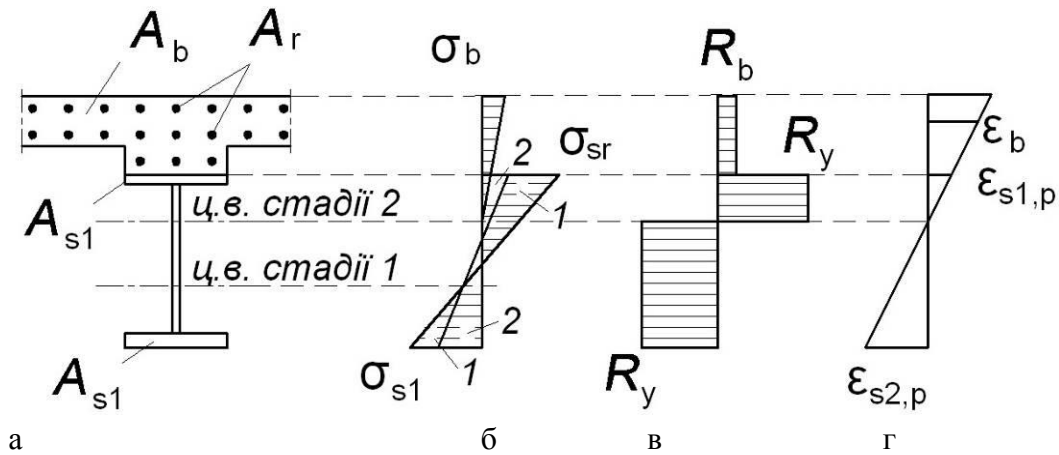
Епюри напружень у перерізі сталезалізобетонної балки:
